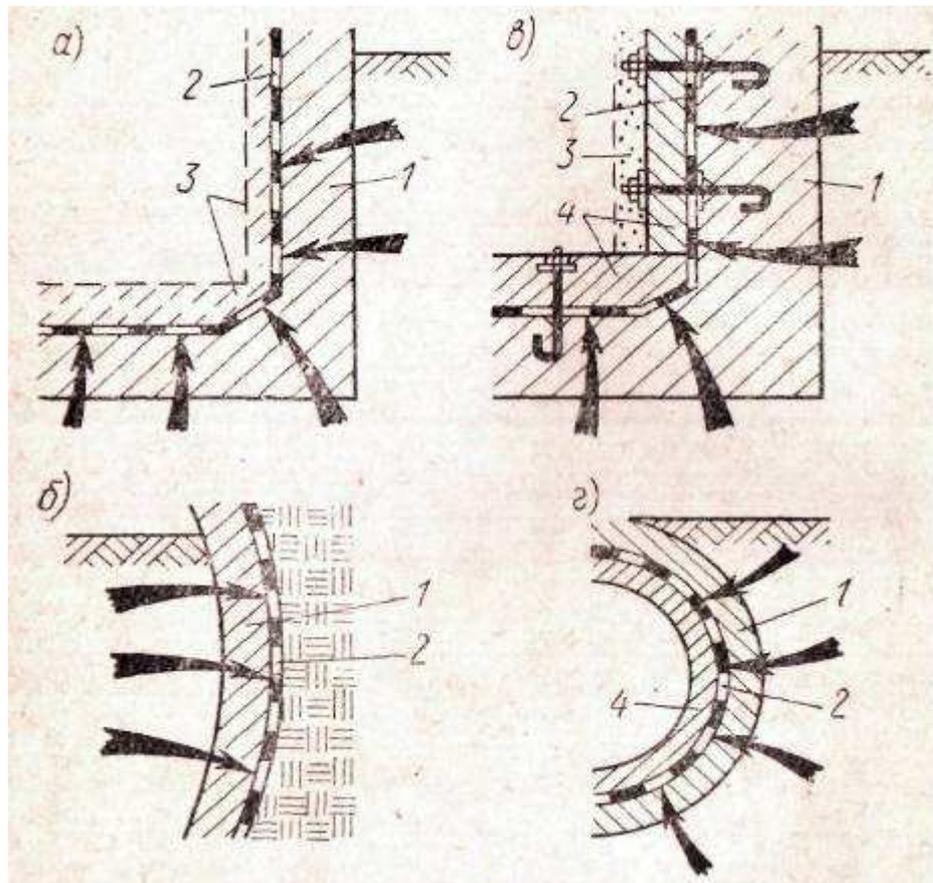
Конструкции гидроизоляции, работающей на отрыв (к п. 2.25)
